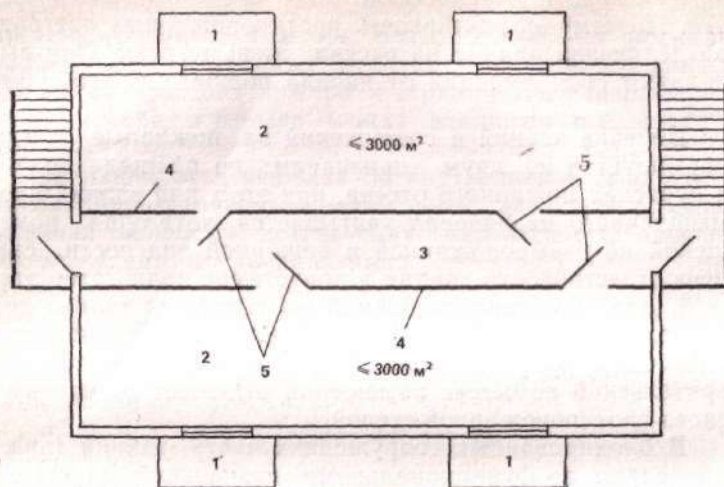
Схема размещения пожароопасных помещений в подвальных помещениях
